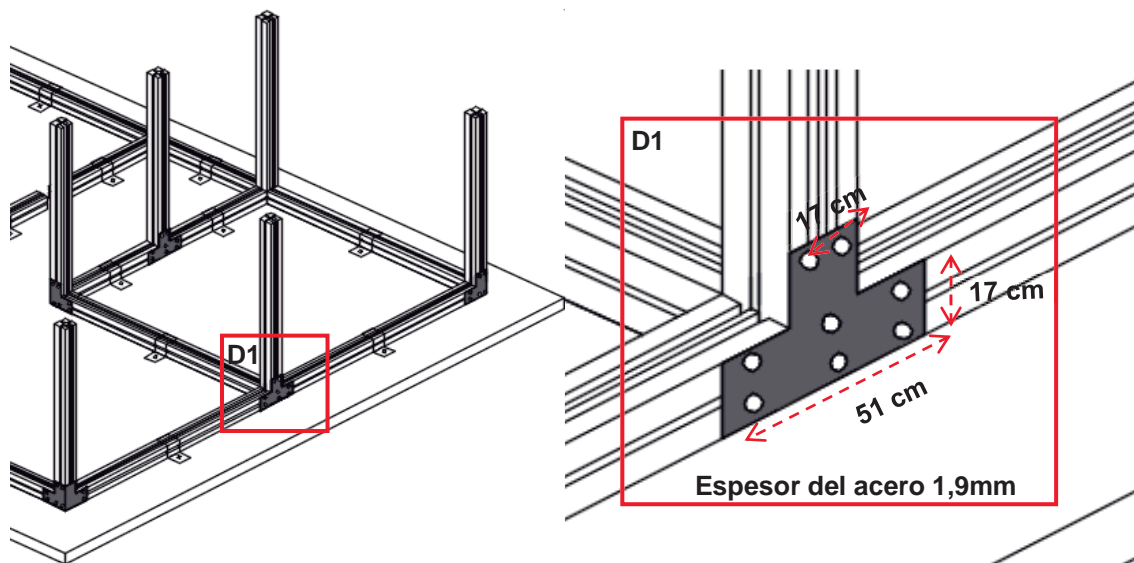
Anclaje de vigas con columnas - AutoCAD, 2018
